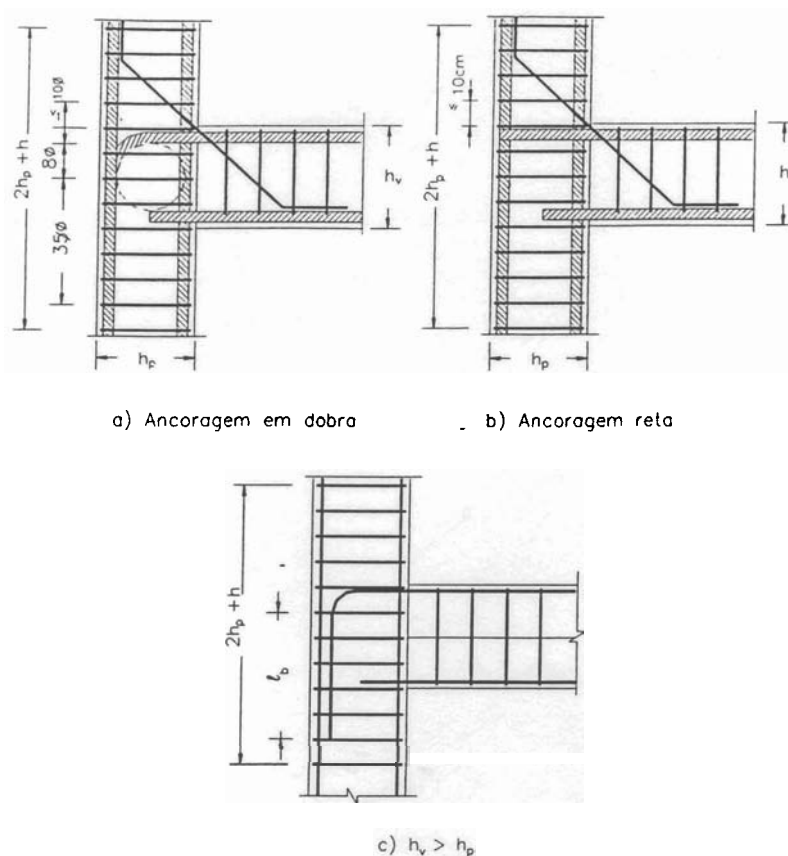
Arranjo de armadura para ligação viga-intermediária [LEONHARDT & MÖNNIG, 1978]
